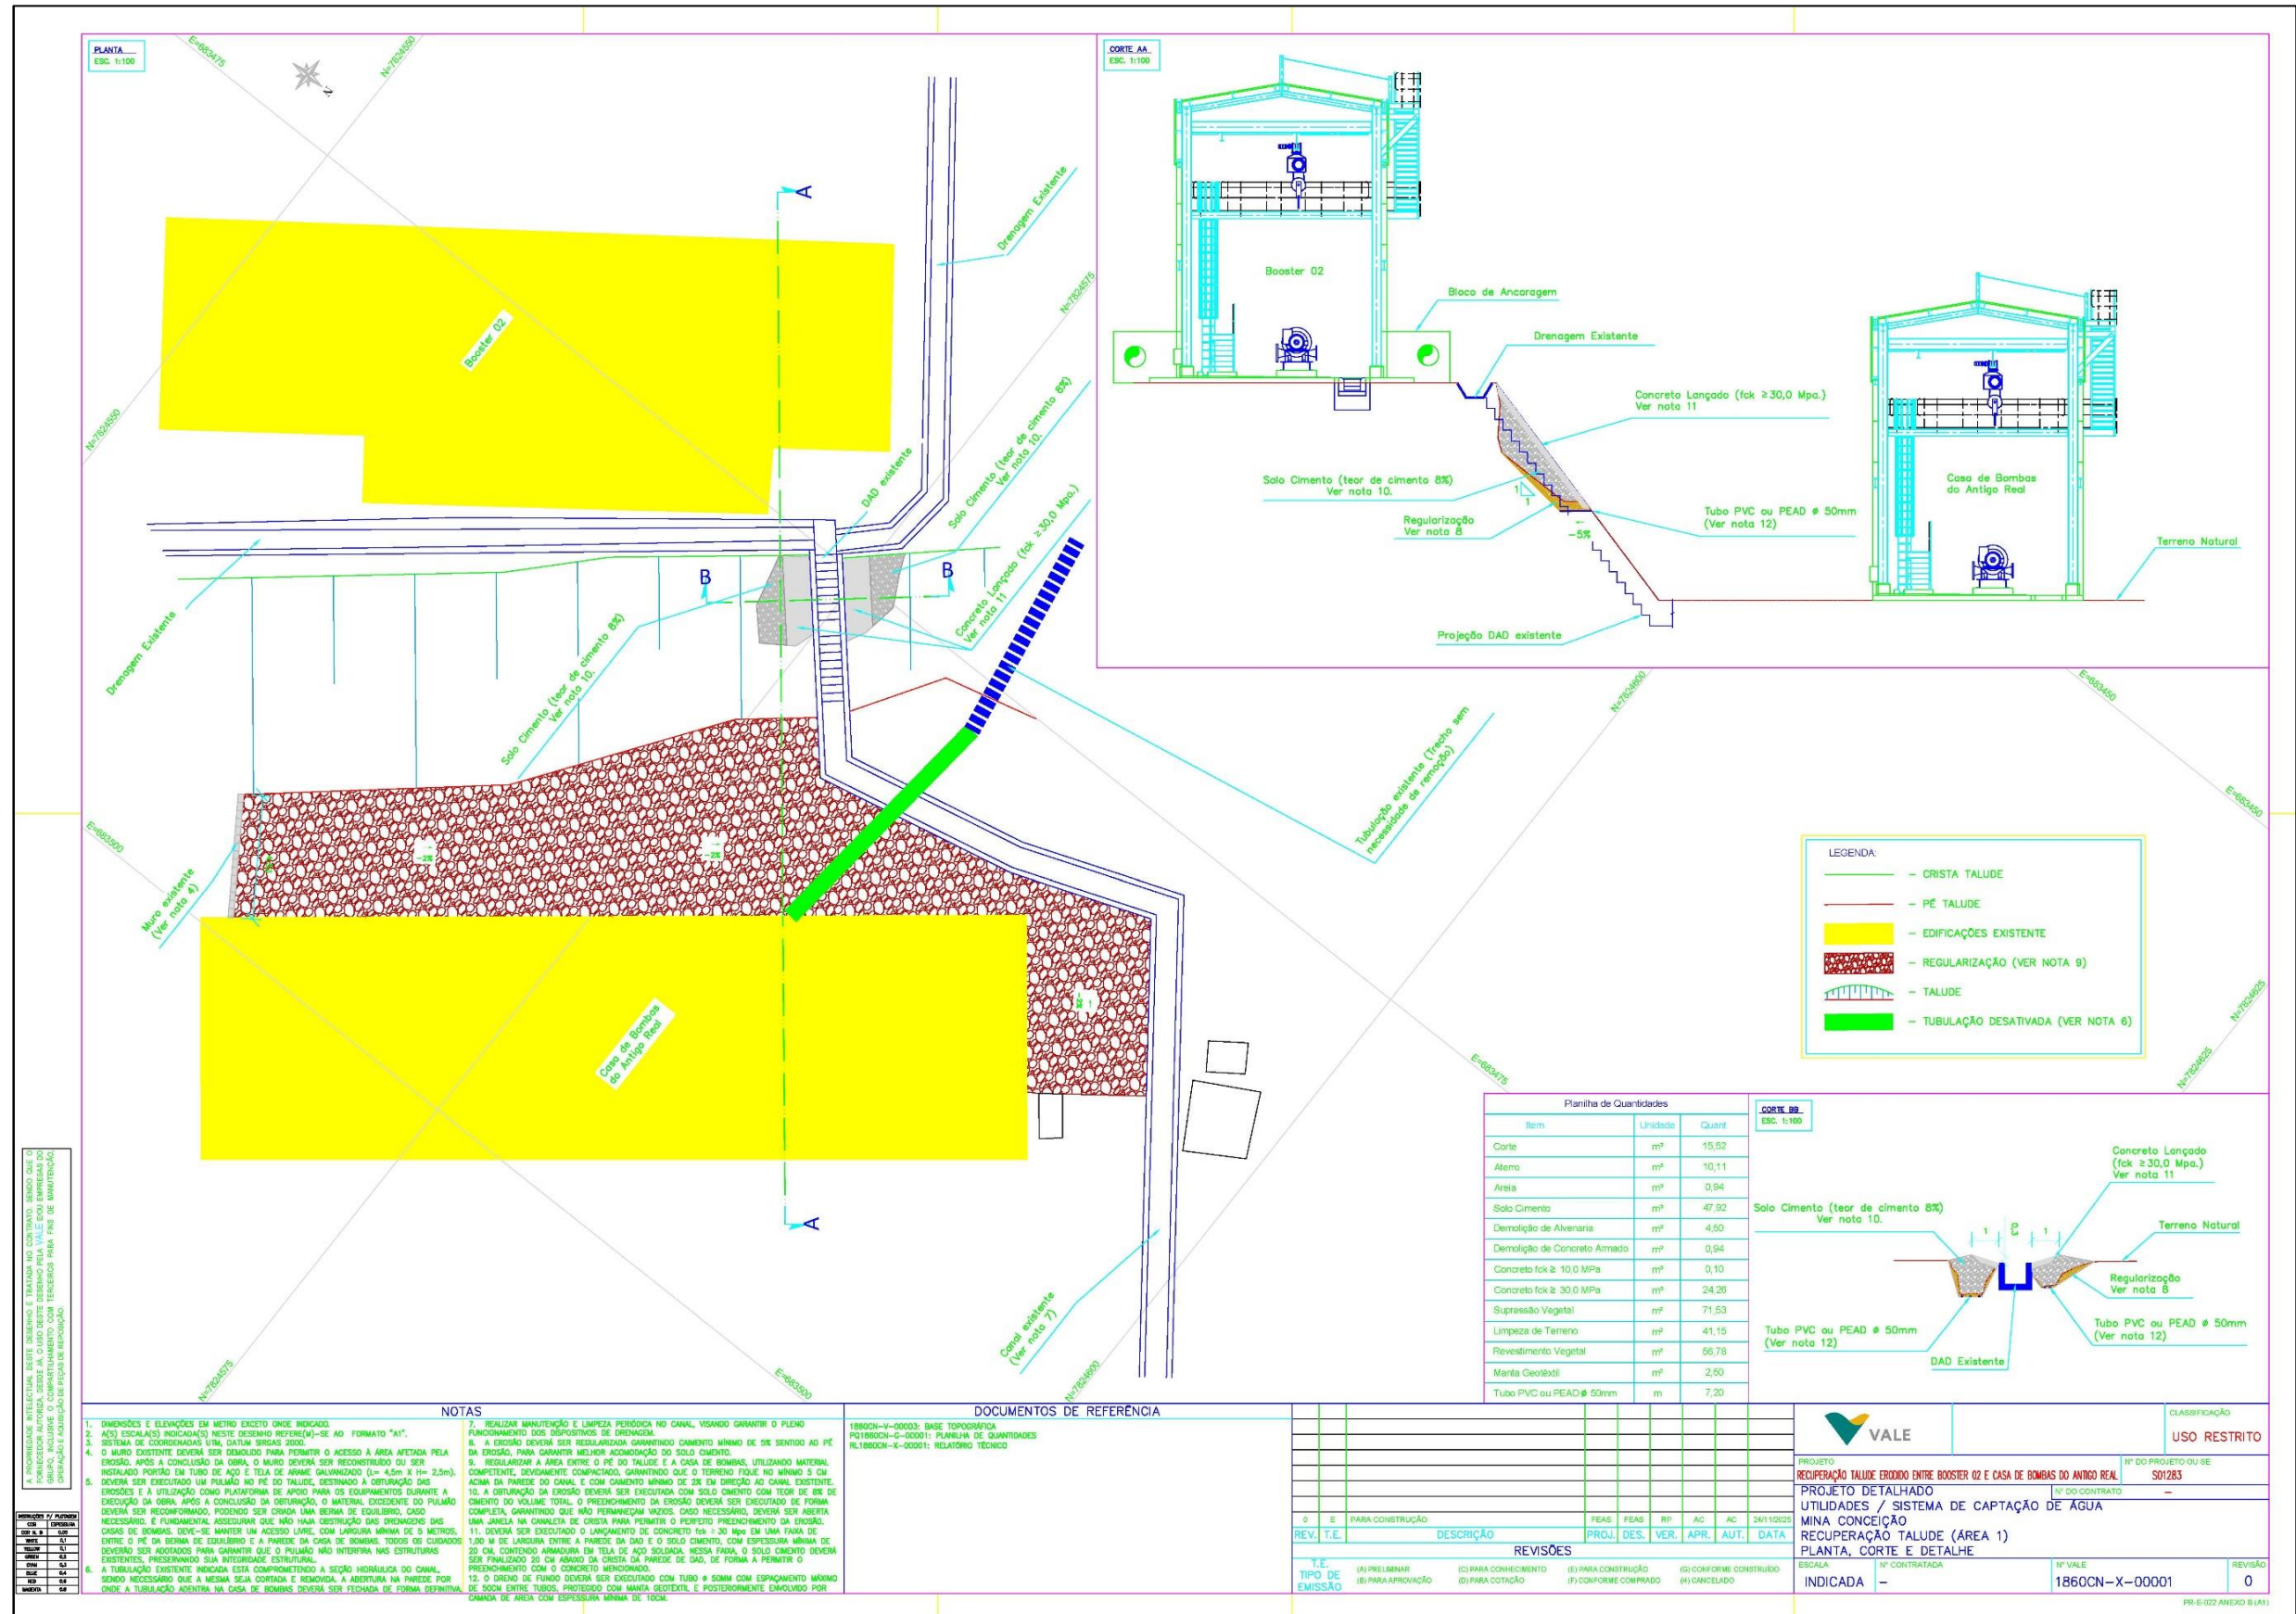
Planta da área prevista para as obras do Talude 1 – recuperação e escada hidráulica.
